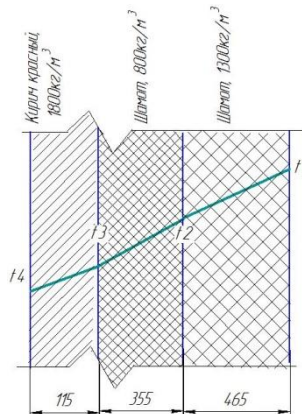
Разрез футеровки стены на 6–10позициях
